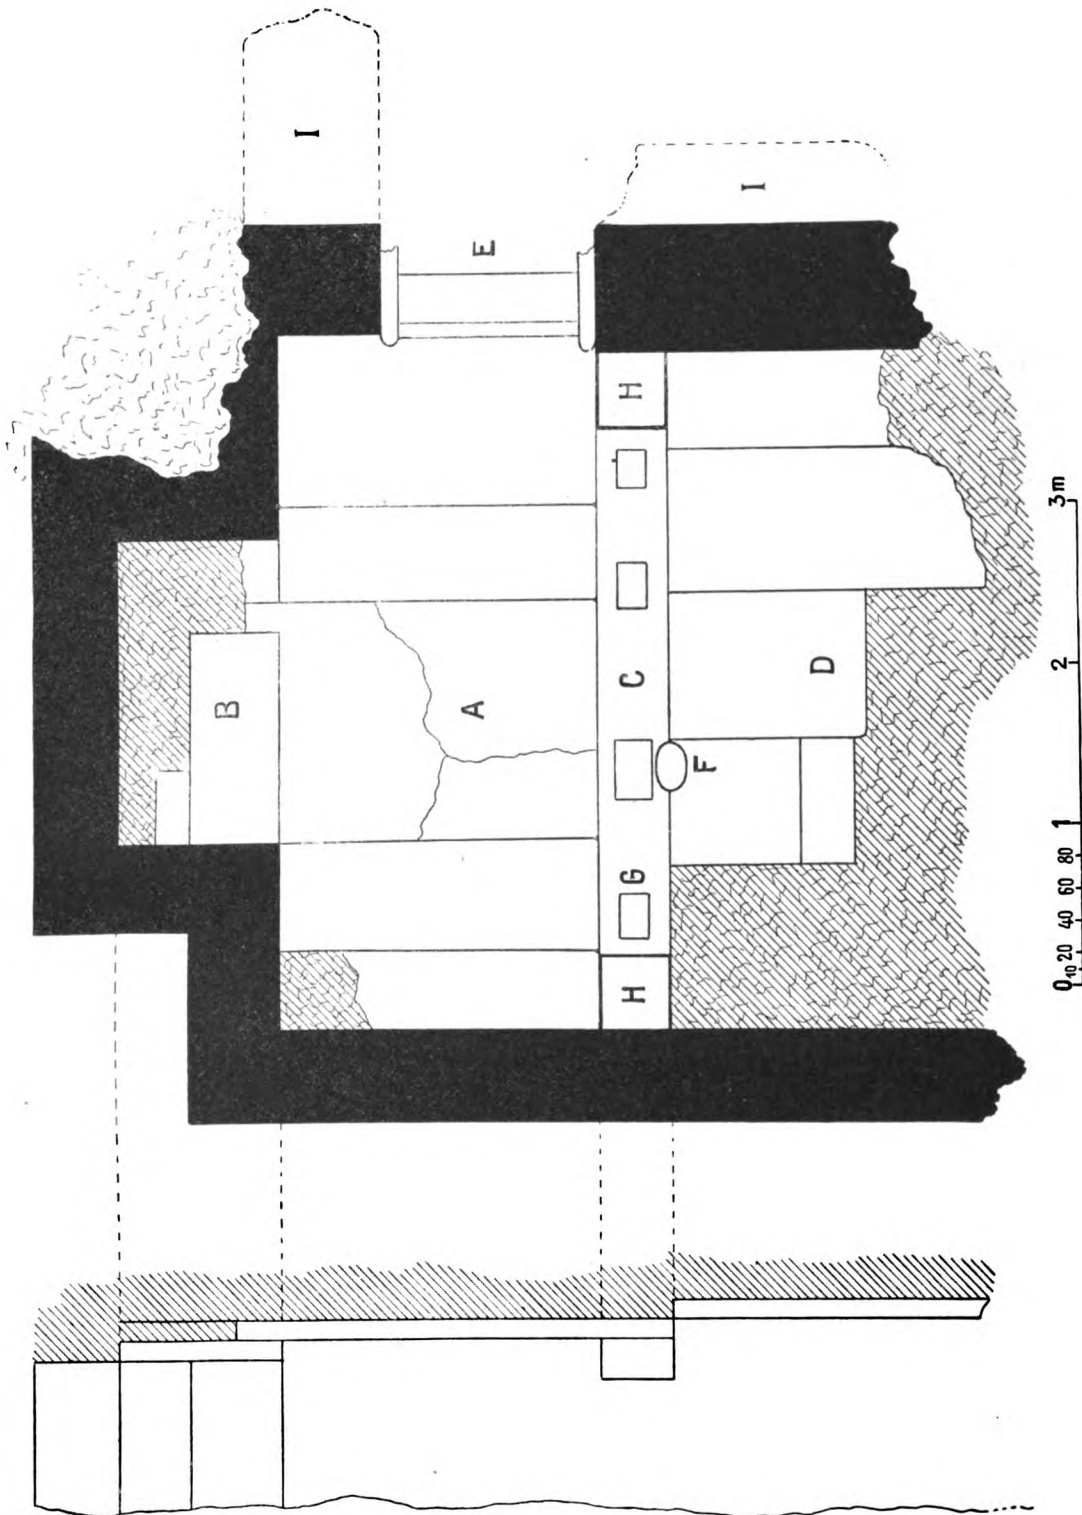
Grundriß eines mittelalterlichen Kirchleins
